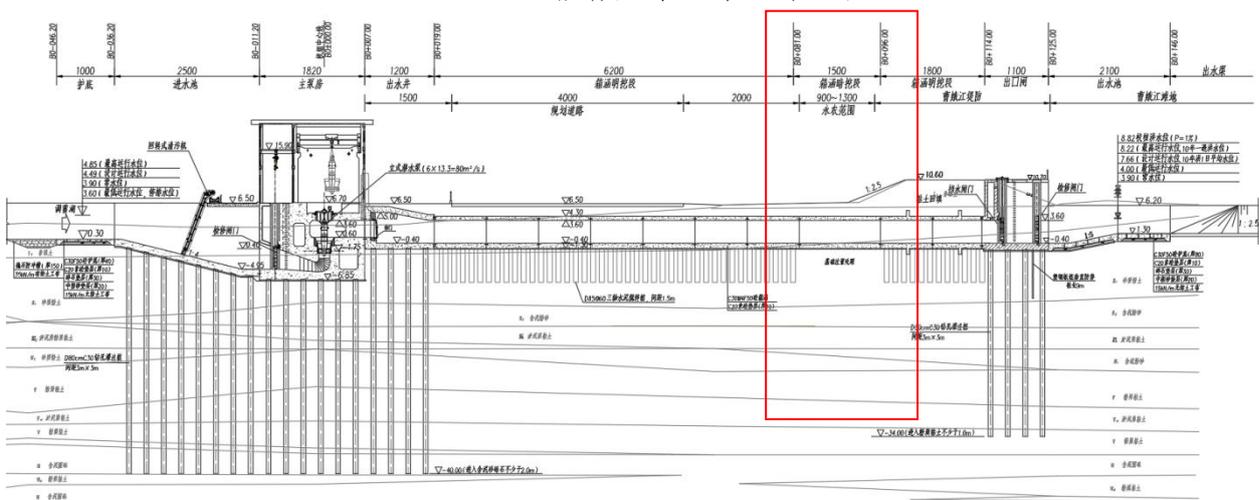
箱涵永农暗挖方案泵站纵剖面图
